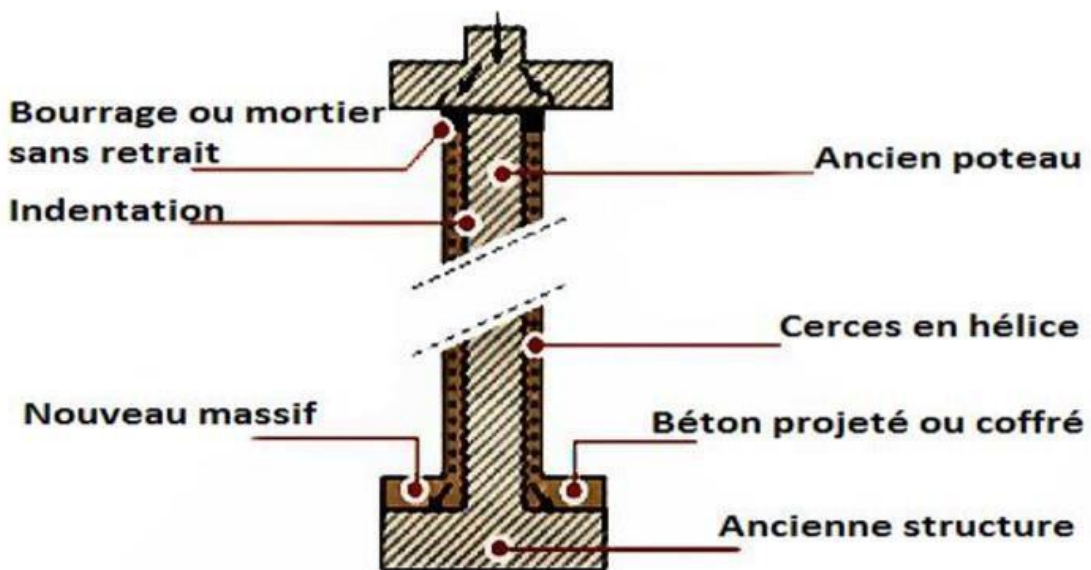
Chemisage en béton armé d'un poteau + fondation renforcée (Coupe transversal).
